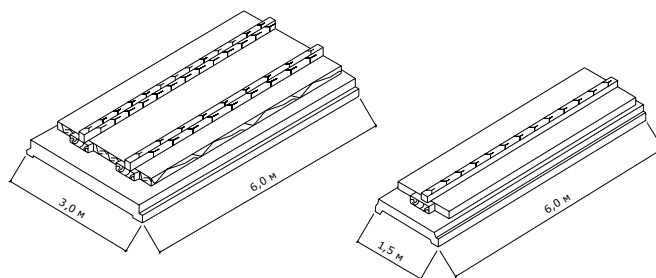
Комплексні залізобетонні плити вентиляюємих покриттів
